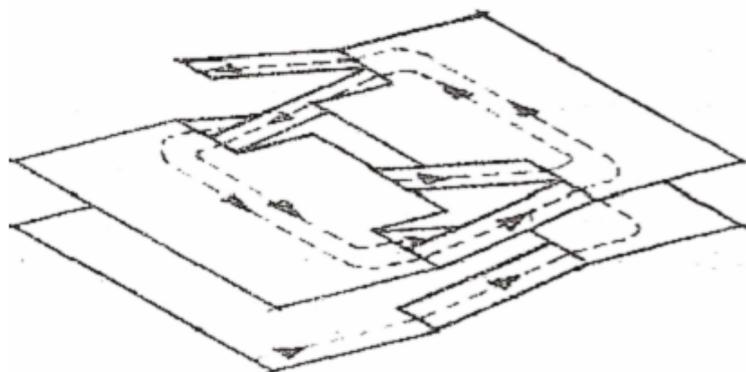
Rampas retas separadas paralelas (TET, 1970)
